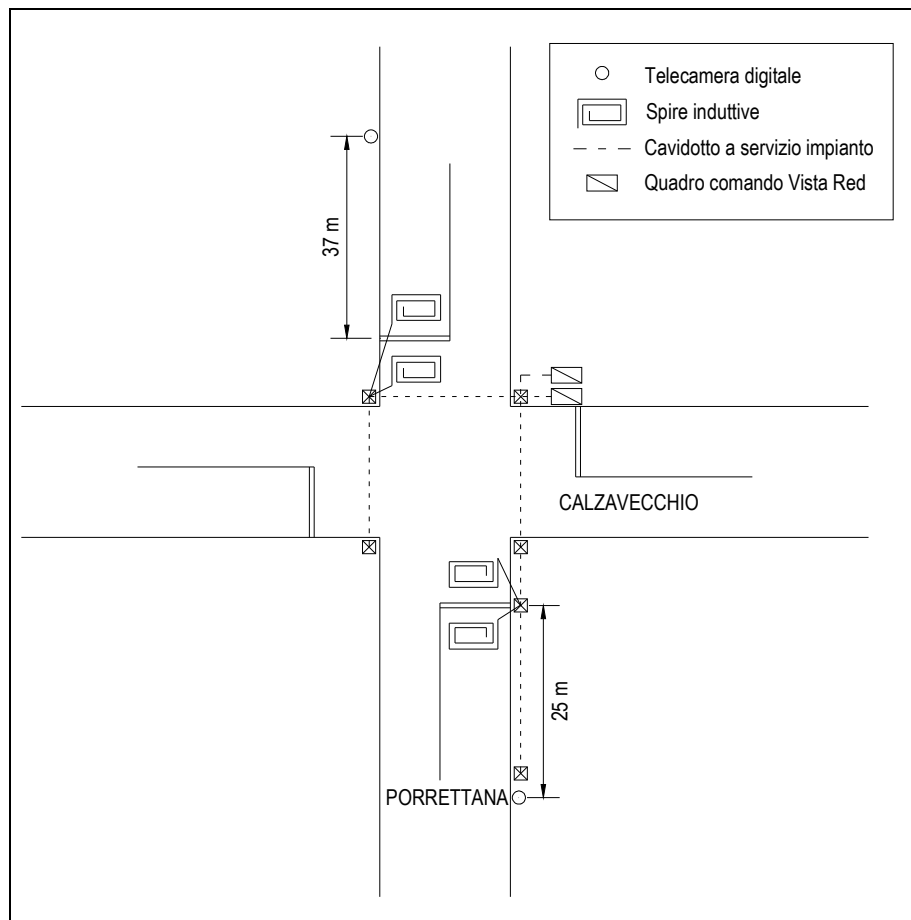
Schema dell'apparecchiatura installata nell'intersezione Porrettana - Calzavecchio.
